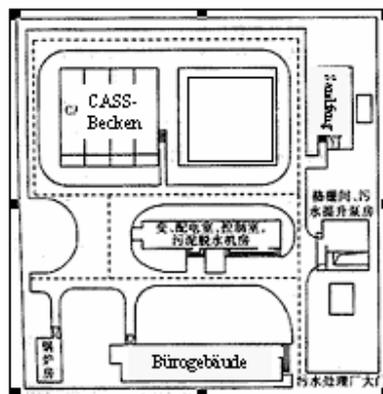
Lageplan der Kläranlage „ Hang-Tian“
